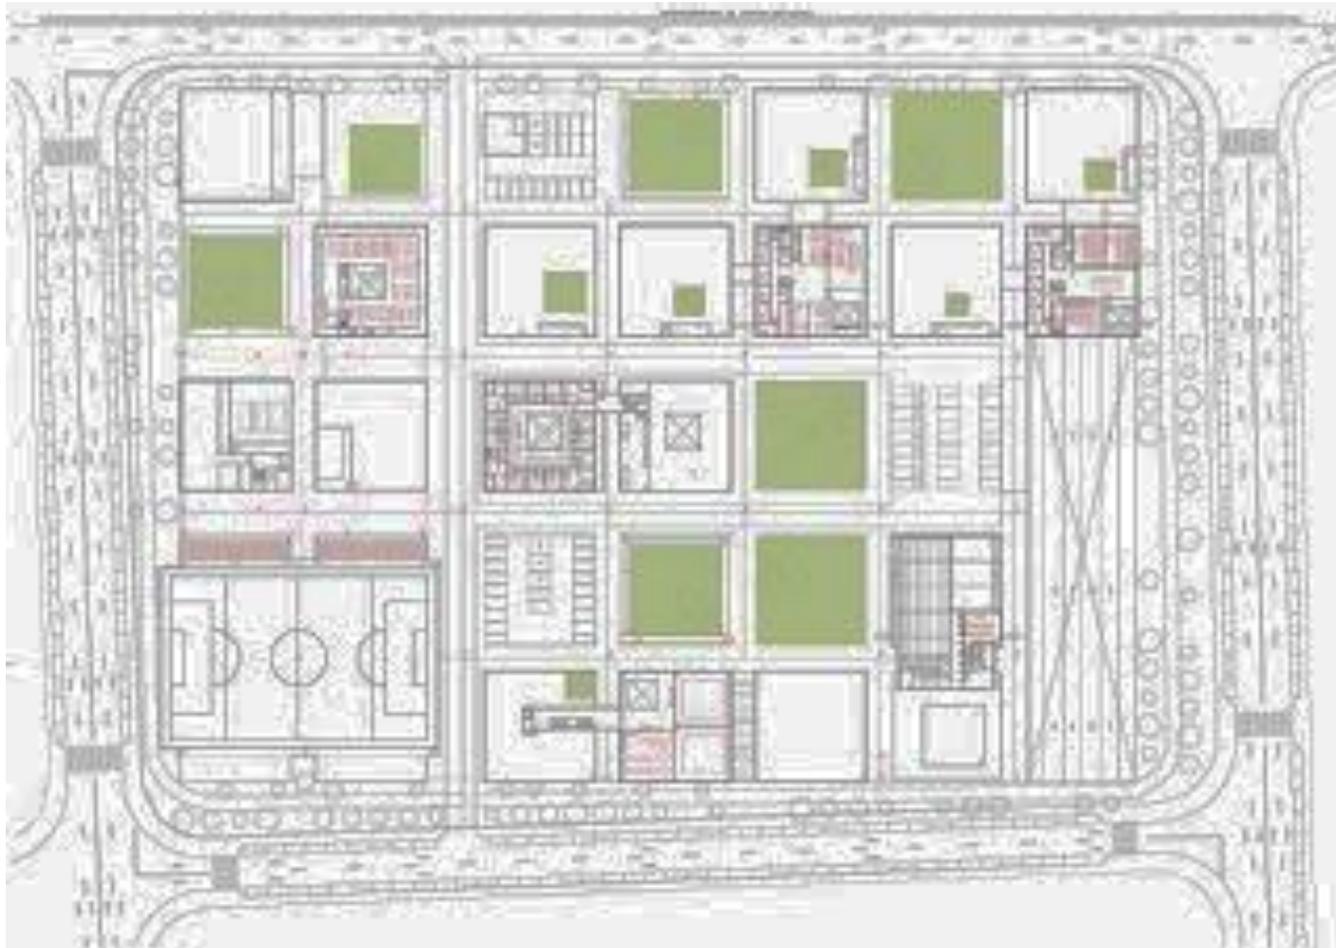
Planta de Conjunto academia de policías de la región de Murcia.
